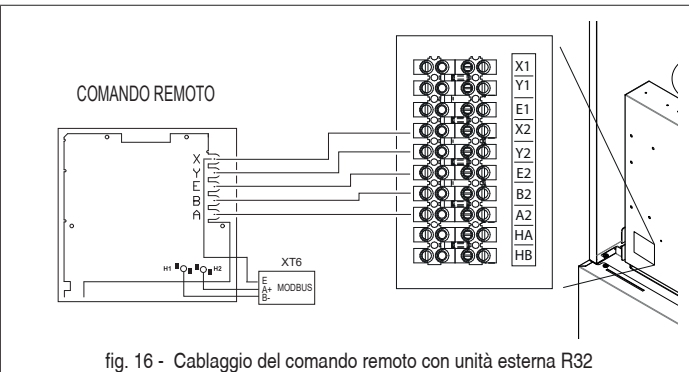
Cablaggio del comando remoto con unità esterna R32
